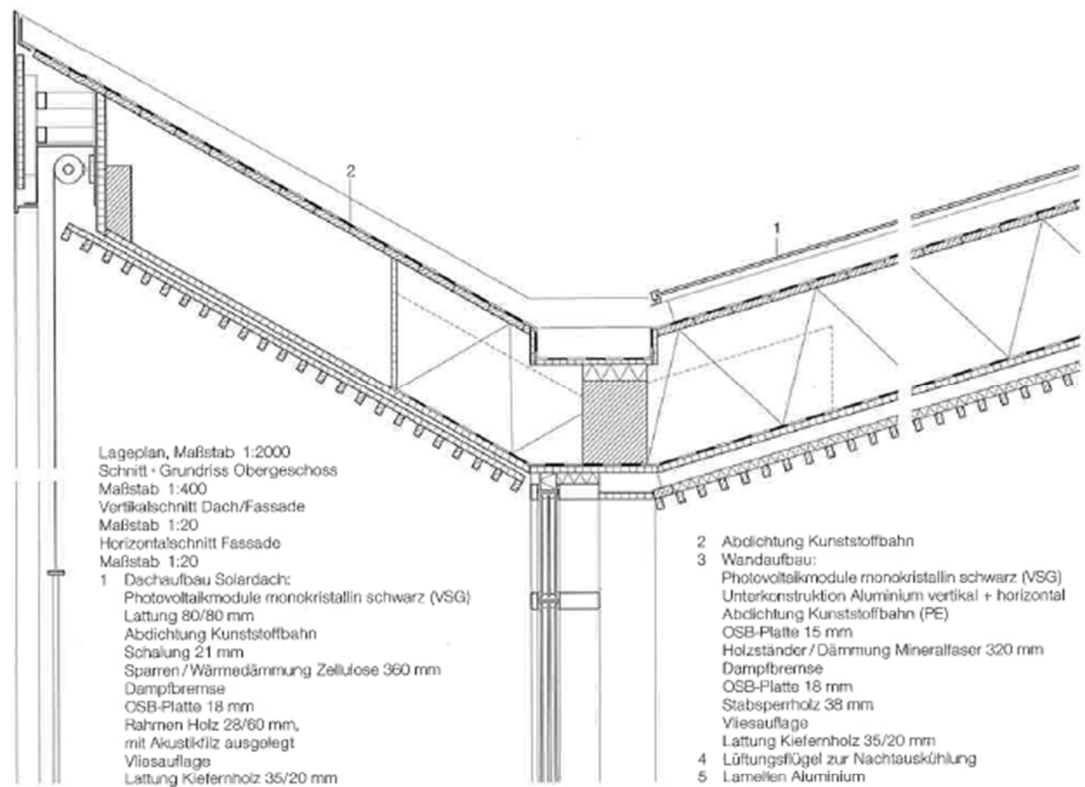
Ausführung einer Fassade mit PV als Ersatz konventioneller Wandmaterialien (leichte, hinterlüftete Wandverkleidung) (Lückmann, 3/5 Integrierte Fassaden - Photovoltaikfassaden, 2014, S. 143)
